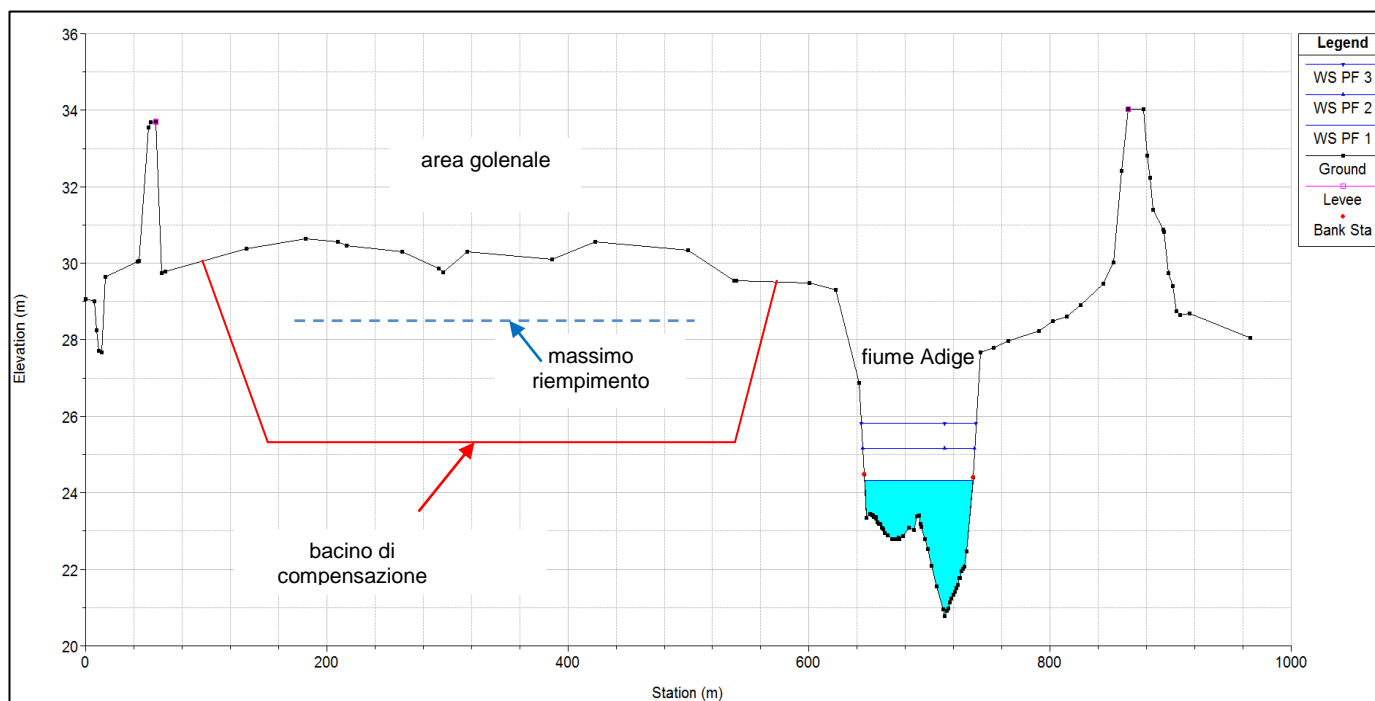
Sezione trasversale 1049 fiume Adige.
